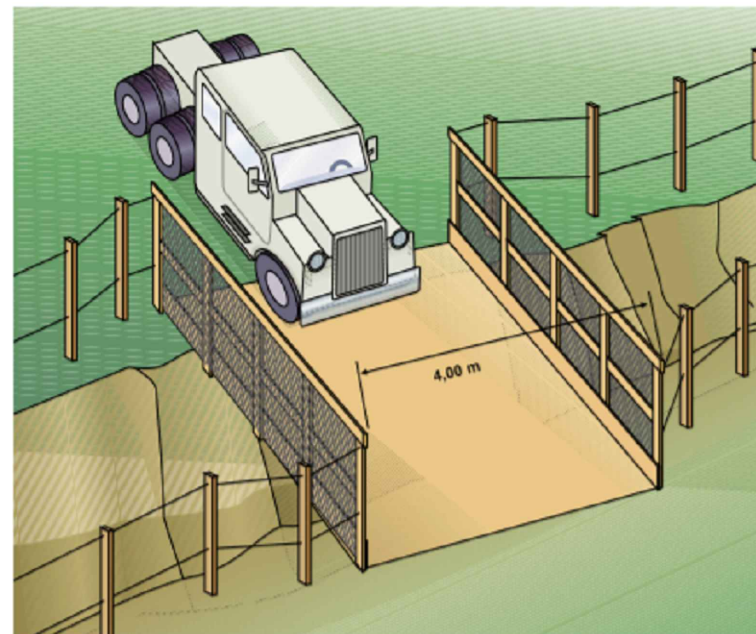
Passarela para o tráfego de veículos sobre escavação
